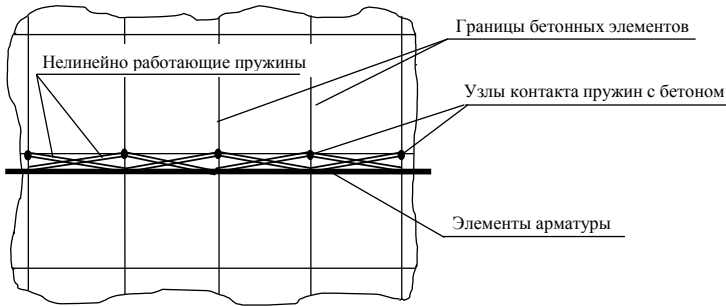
Фрагмент расчетной схемы железобетонной конструкции
